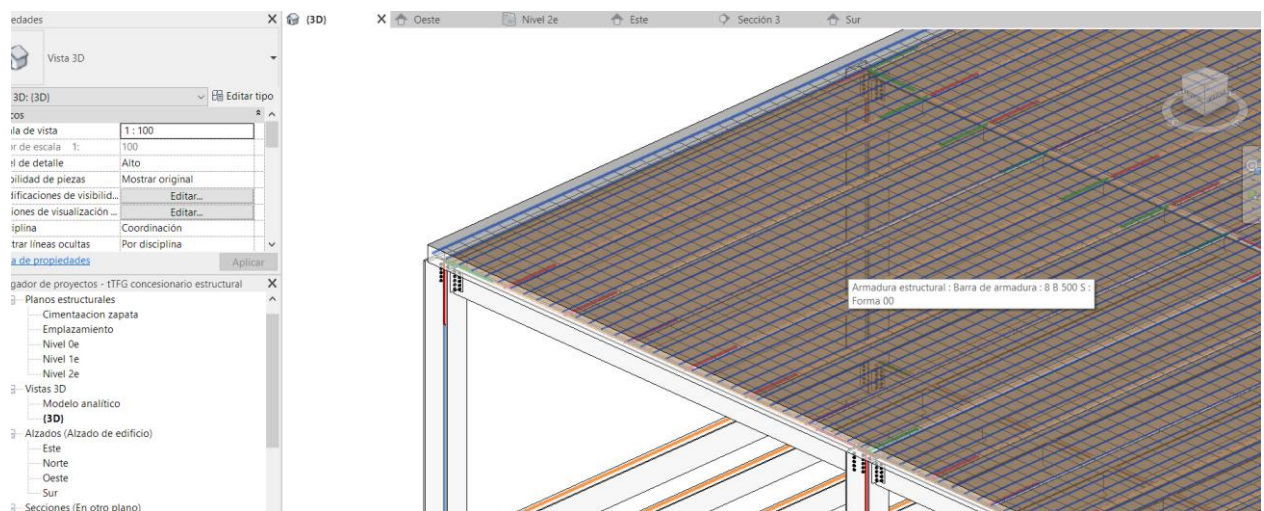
Vista 3D losa de la azotea con armadura de acero.
